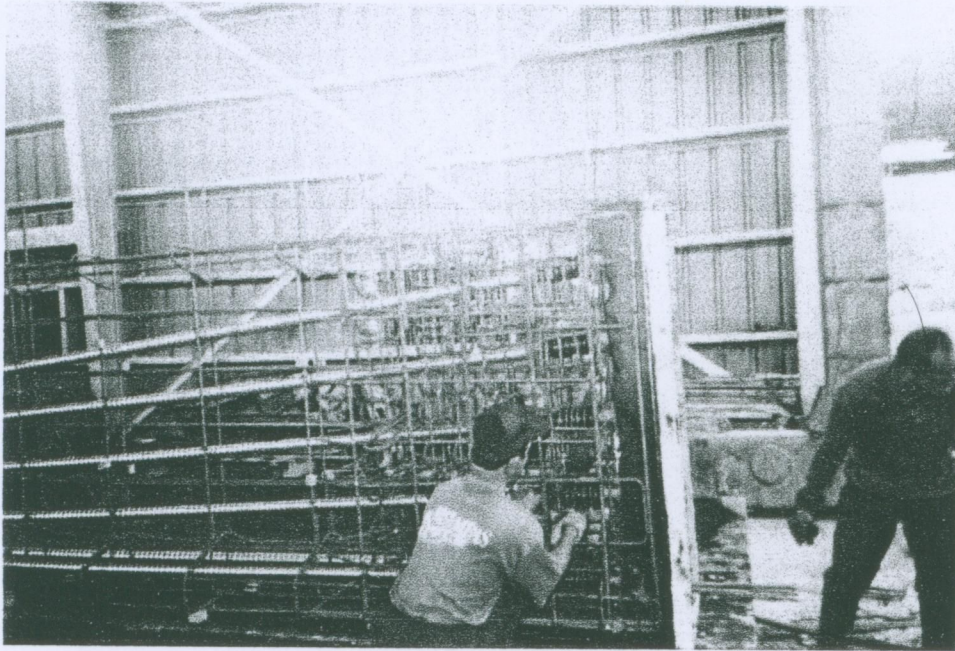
Pemasangan Tulangan Balok Prategang Pracetak Segmental
